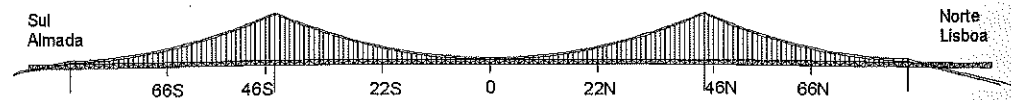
Secções instrumentadas nos ensaios da ponte 25 de Abril
